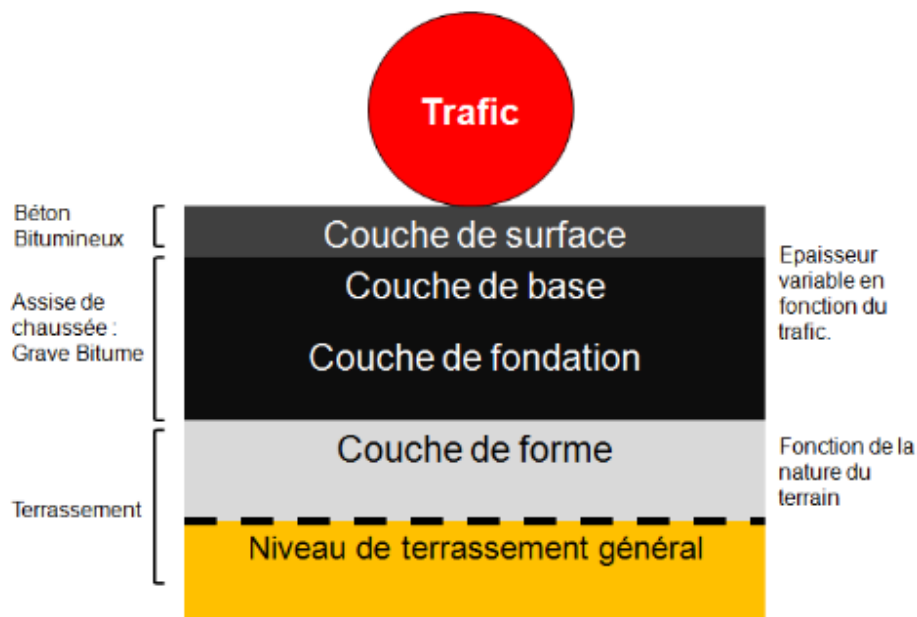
Structure type d'une chaussée bitumineuse épaisse
